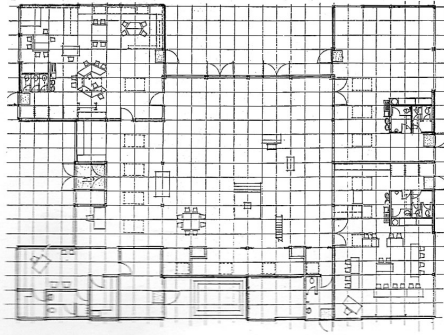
Edificio de bachillerato, planta primera, proyecto septiembre 1969. F: AMCB
